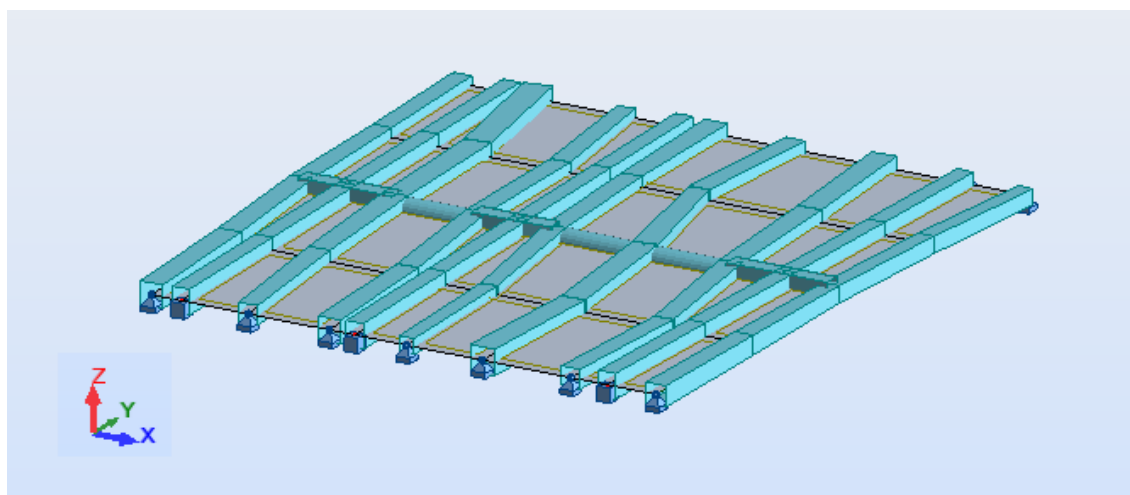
Aspeto do modelo após a colocação das vigas de reforço (fase 2)
